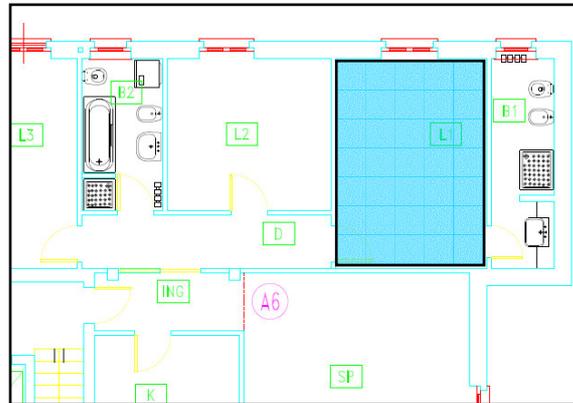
Planimetrie dei piani primo e terra con indicazione della partizione orizzontale testata
